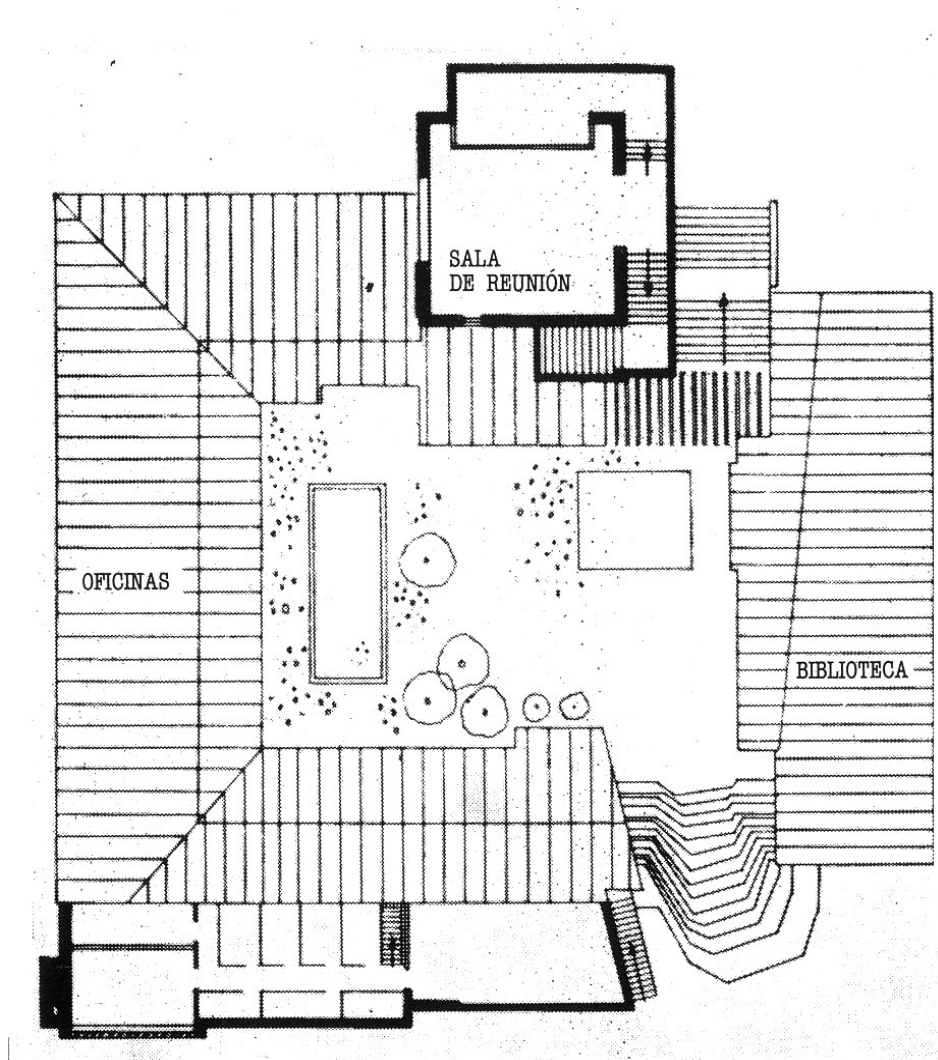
Planta de la sala de consejo del ayuntamiento.
